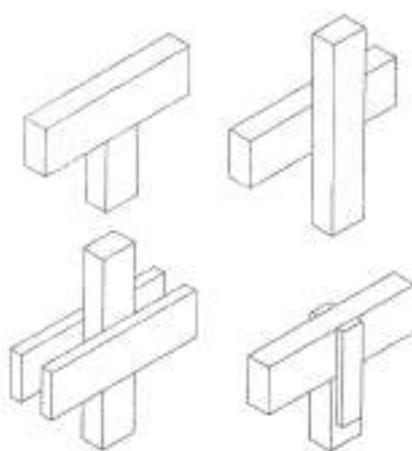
Pormenor de ligações viga - pilar por justaposição
